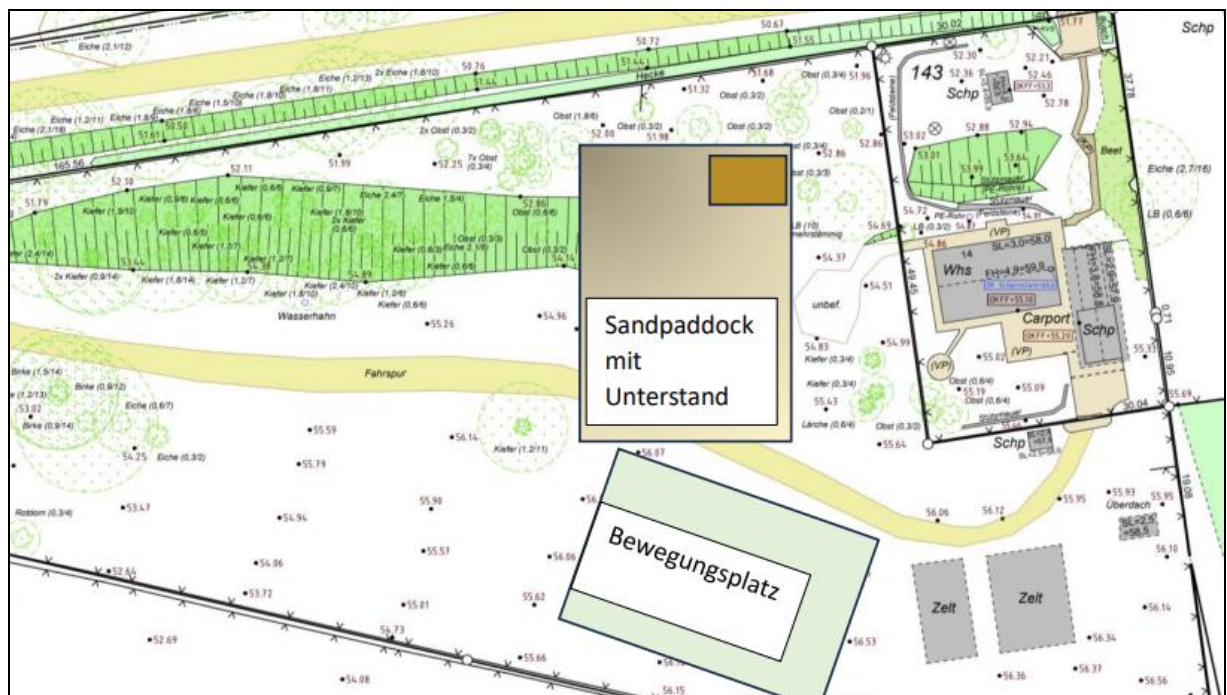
Planskizze der zwei geplanten Anlagen für Pferdehaltung und baulicher Bestand, eigene Darstellung
